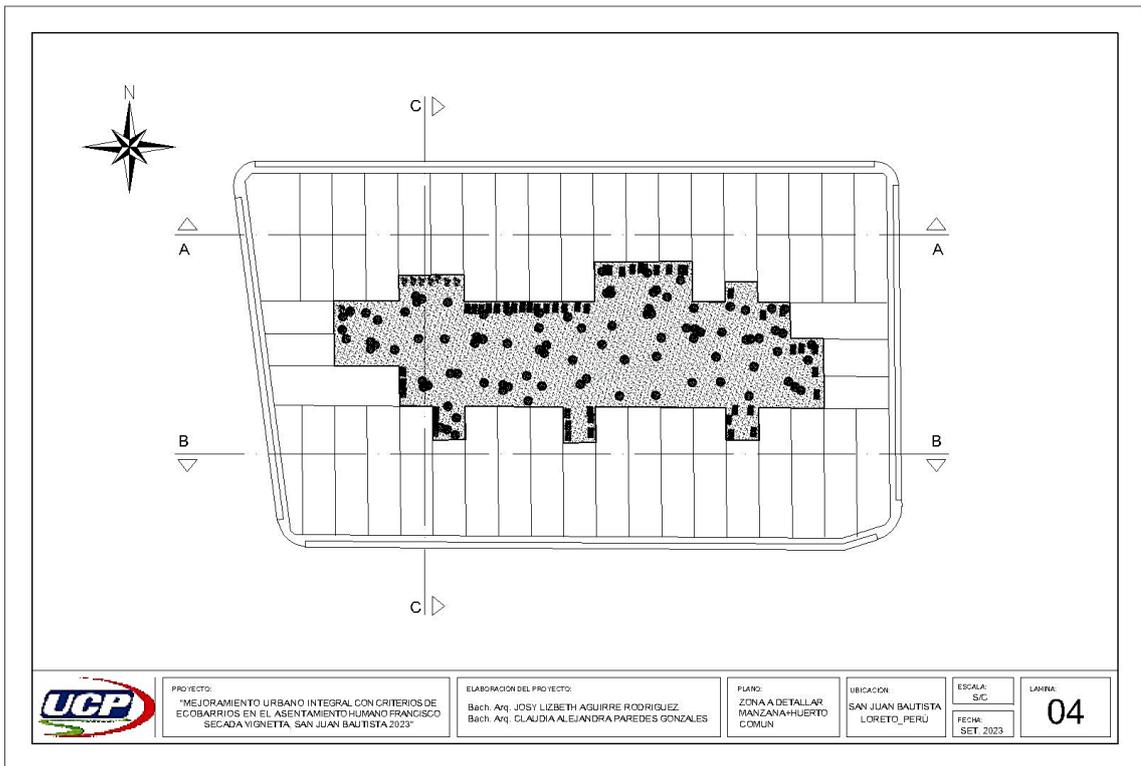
Zona a Detallar – Manzana – Vivienda Huerto
